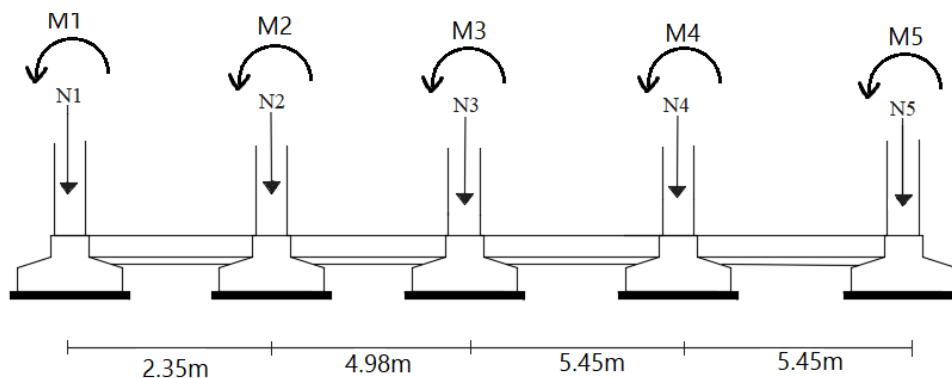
Schéma d'une Semelle filante (Axe x-x)
